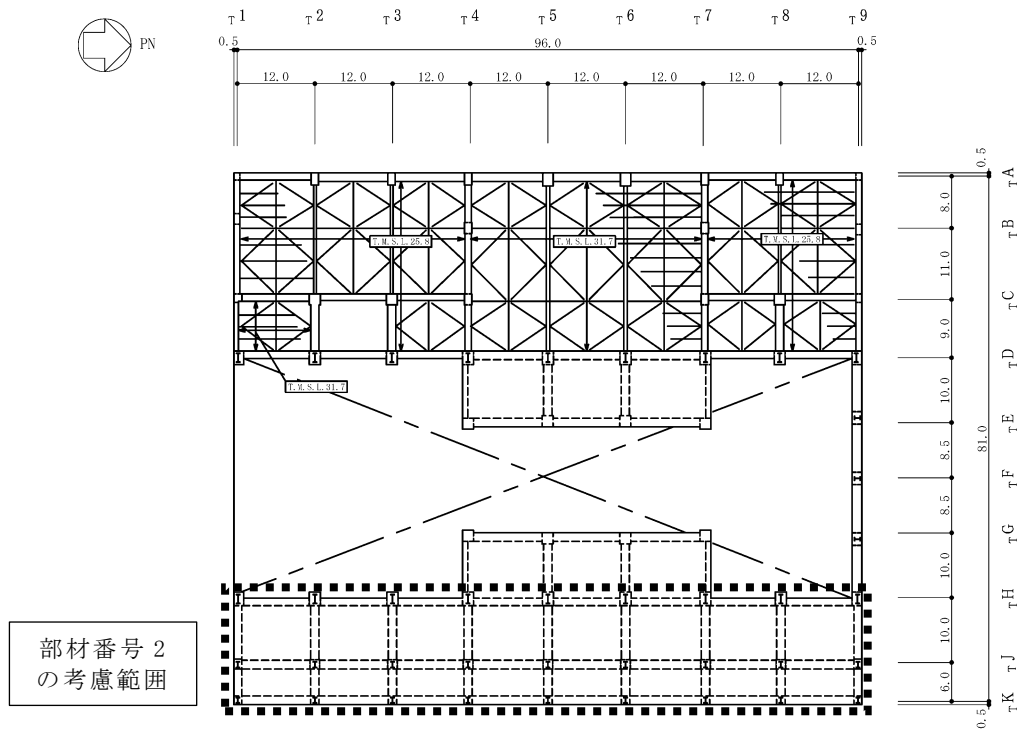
6号機タービン建屋の概略平面図 (T.M.S.L. 30.9m) (単位 : m)
